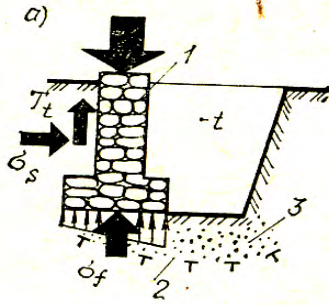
Порушення природного стану ґрунту основи при його проморожуванні в процесі влаштування котловану з поруч розташованим фундаментом існуючого будинку: 1 – існуючий фундамент; 2 – границя сезонного промерзання ґрунту; 3 – мерзлий ґрунт;  $\sigma_s$  і  $\sigma_f$  - нормальні напруження по боковій поверхні та по підшві фундаменту;  $T_t$  – сумарна дотична сила випучування
